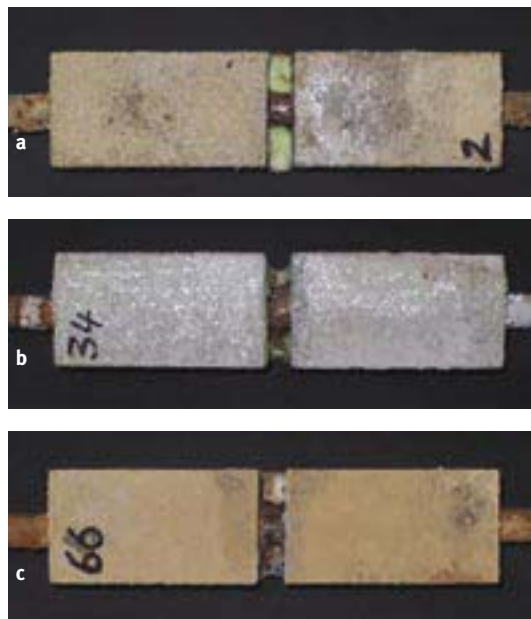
Prismen nach acht Wochen Lagerung mit freigelegtem Bewehrungsstahl (a: Wasserlagerung, b: Luftlagerung, c: Wechsellagerung)
